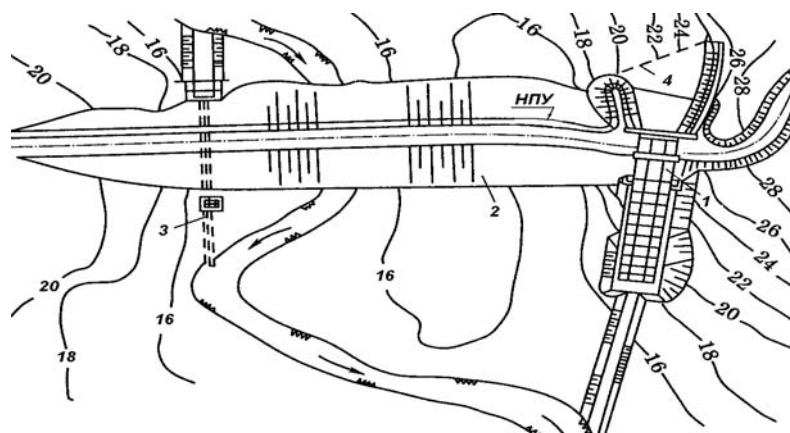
Гидроузел с грунтовой плотиной, открытым нерегулируемым водосбросом и донным водоспуском:
